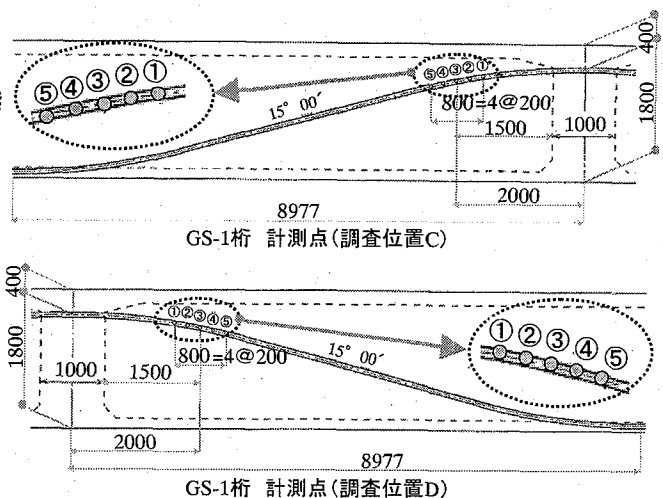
桁側面およびケーブル配置図：S 橋梁 GS-1 桁
